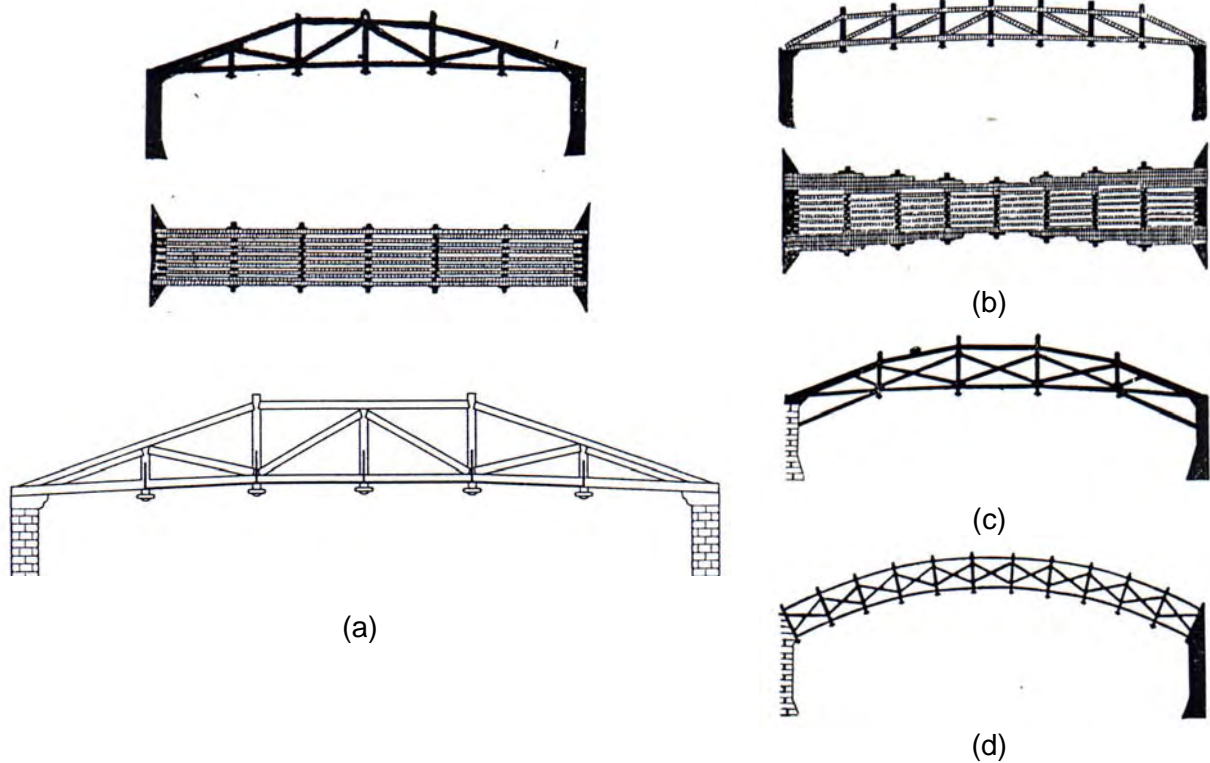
Palladio's Darstellungen der Fachwerkbrücken
